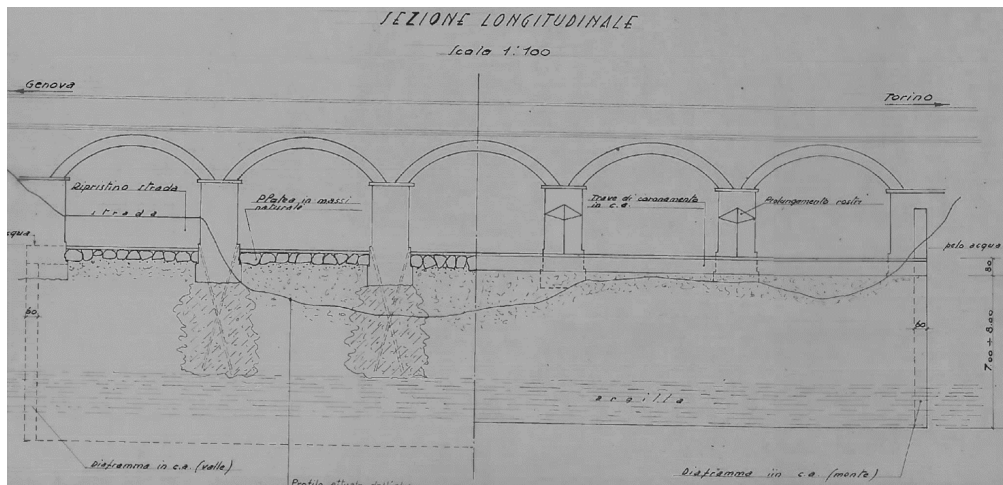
Sezione/prospetto longitudinale, elaborato 4676/273
